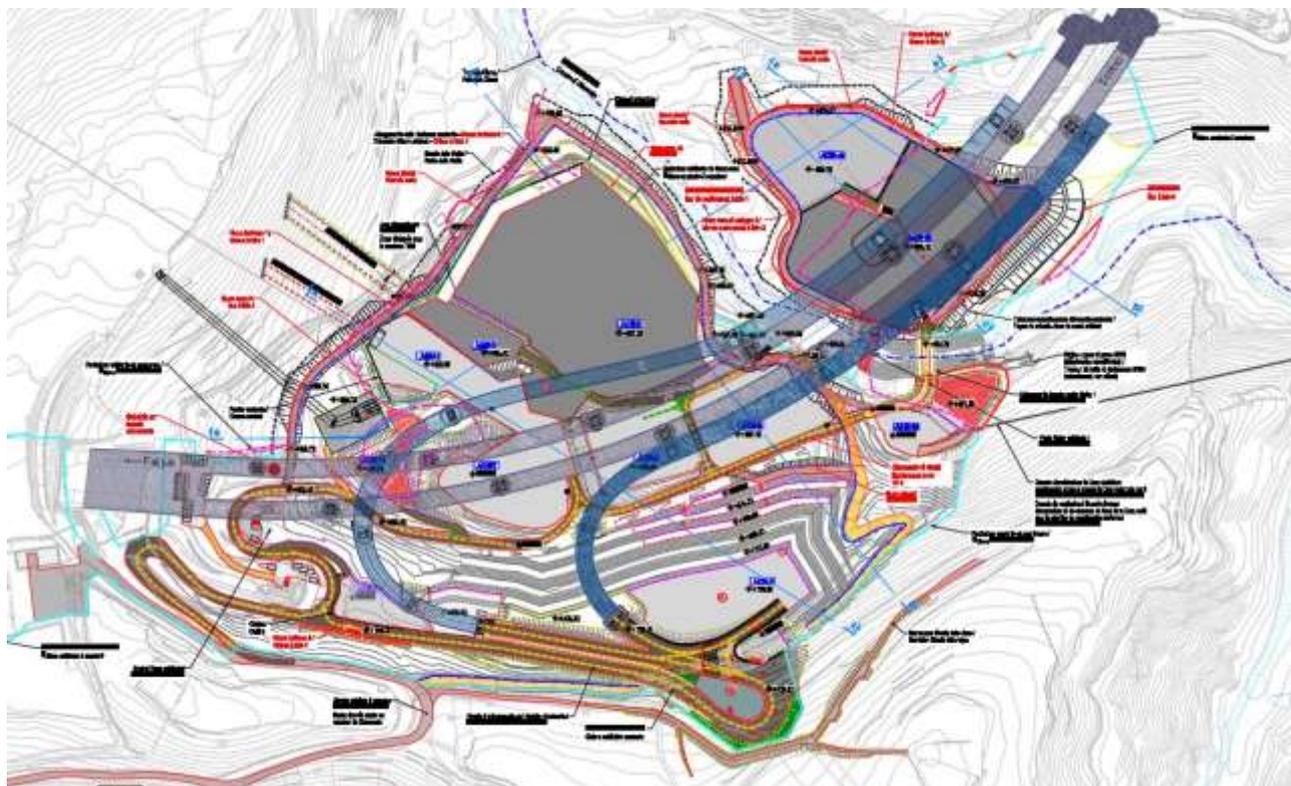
Planimetria area di cantiere con le opere incluse nel PE di 1a fase
